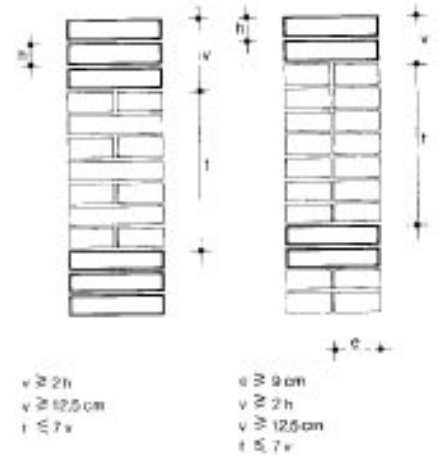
Muro verdugado Figura 4.14 - Muro doblado con verdugadas
